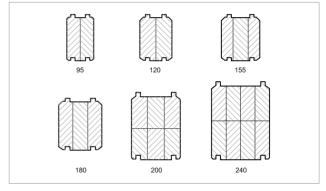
Dimensioni trasversali standard maggiormente diffuse per elementi squadrati.
